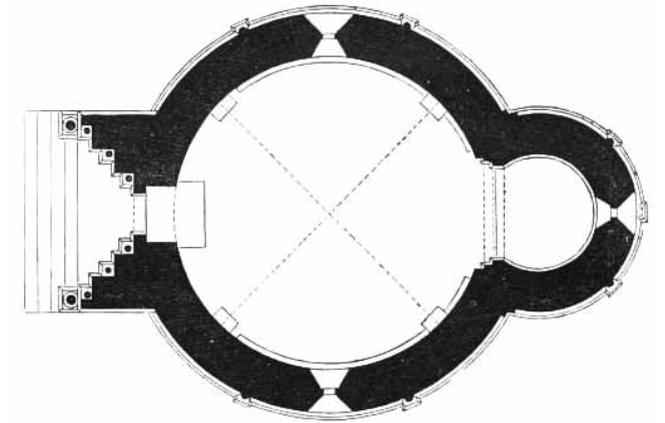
Grundriss Baddeutsch Altenburg (DM 10,45 m), M 1:200. MdkkCC 12/1867, 157.
